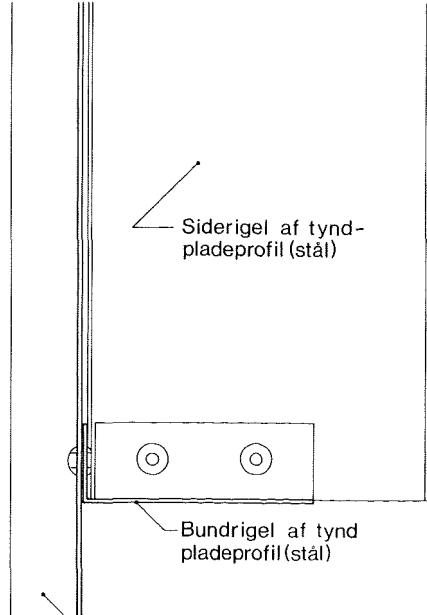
Opstalt af komponent med profileret pladebeklædning (A1).
